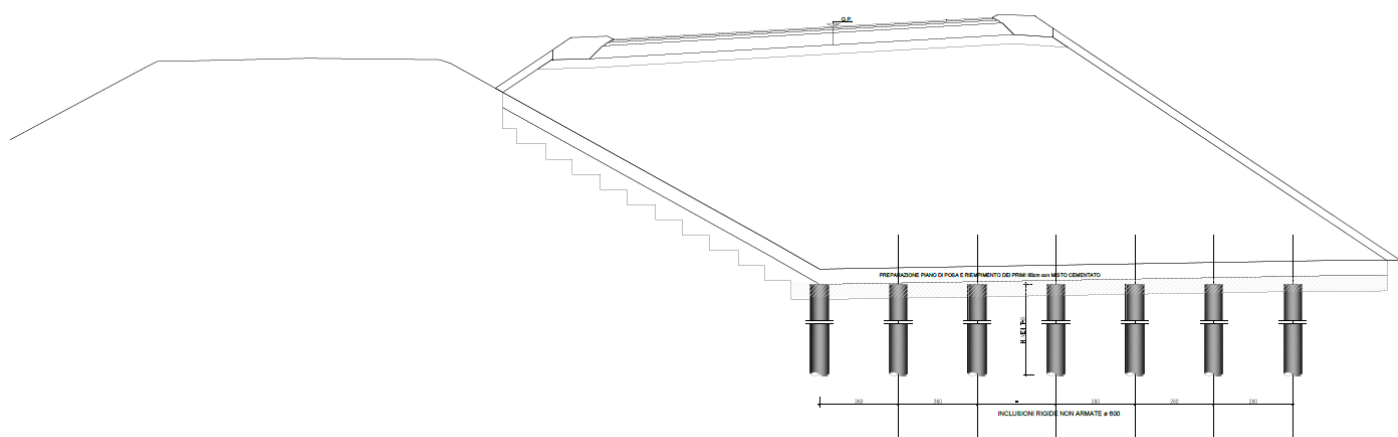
Sezione tipo del rilevato di approccio spalla B con inclusioni rigide
